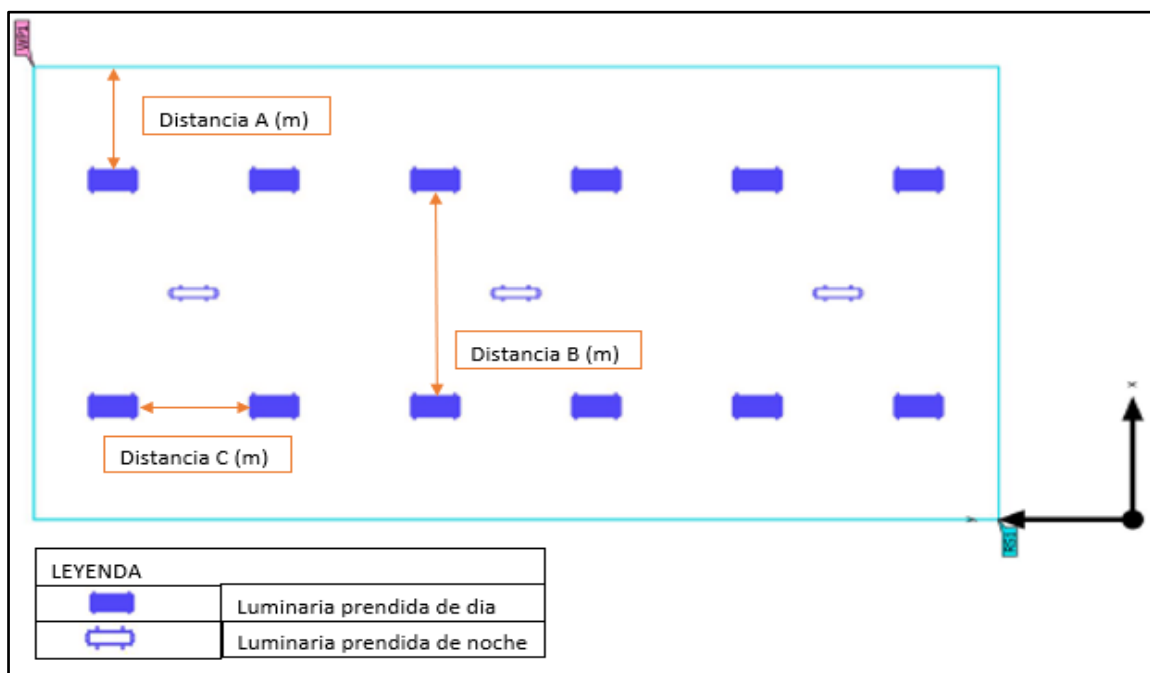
Vista de planta de los detalles de distancias entre luminarias
